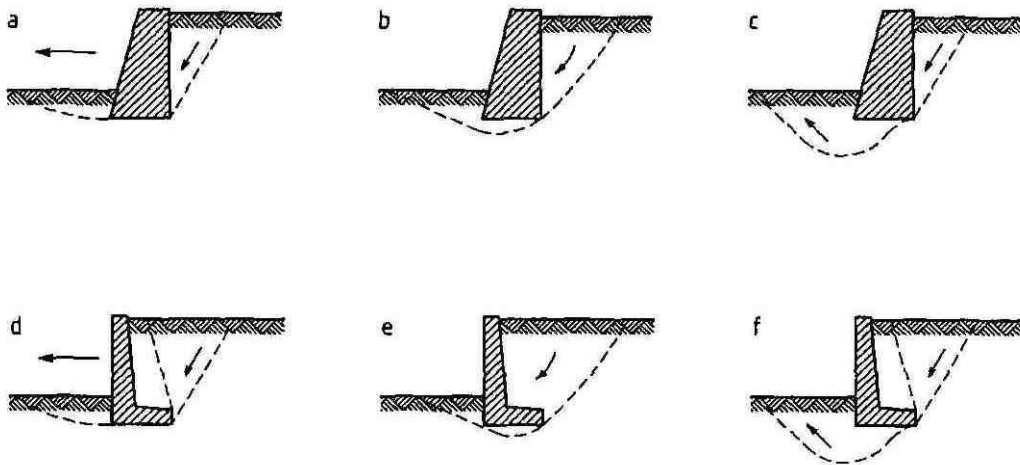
Приклади граничних форм руйнування фундаменту гравітаційних стін
